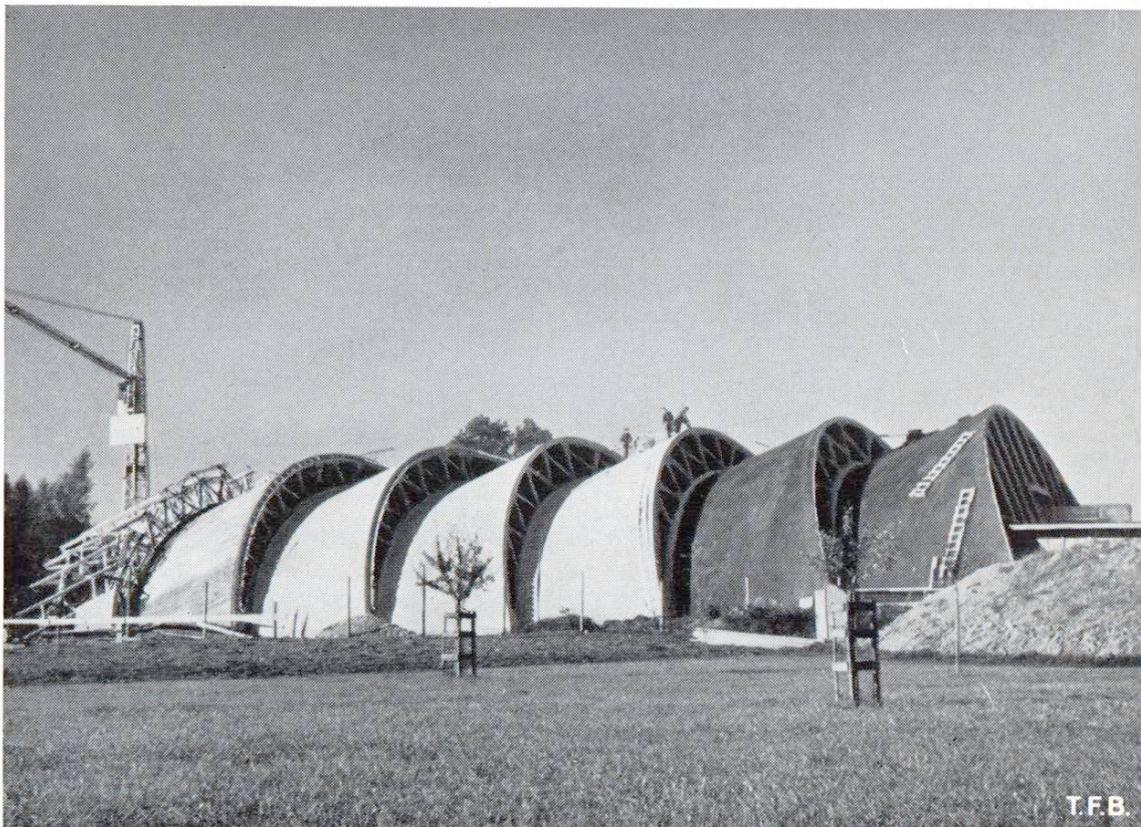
Construction du coffrage d'un voile en coupole pour la couverture d'une salle
